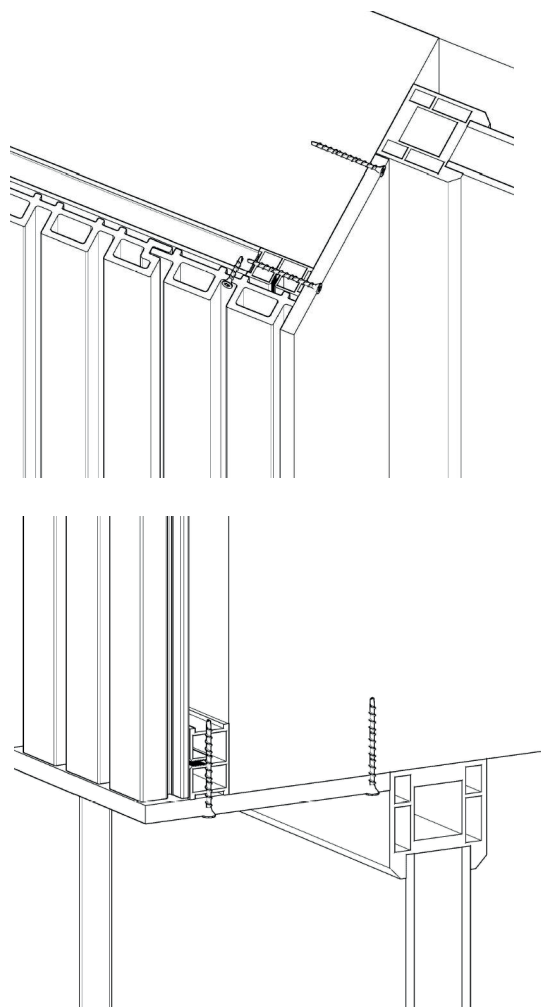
Instalación de perfiles de fachada en las pendientes de las aberturas de ventanas y puertas
